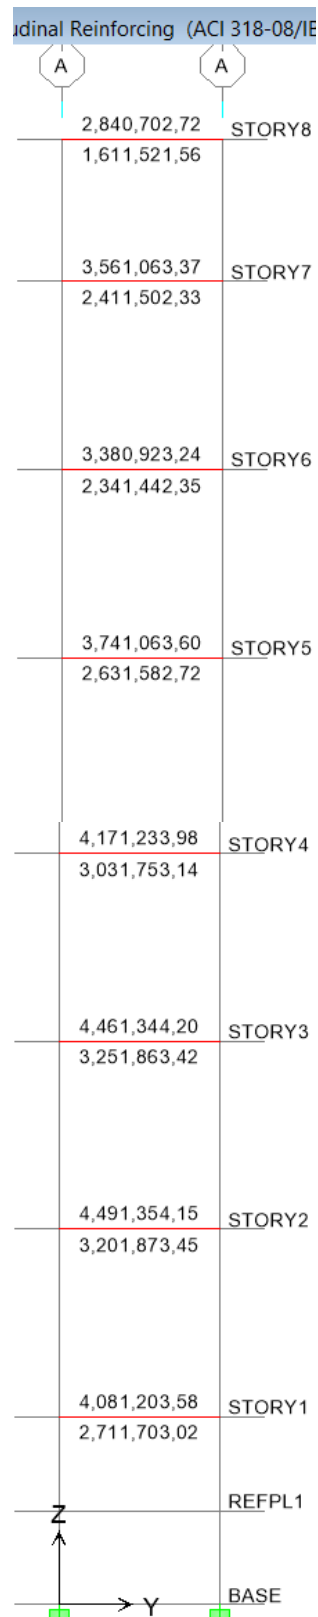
Acero en Vigas y Columnas en el Pórtico A – Escalera Emergencia Hospitalización 2- (CEC-2002)
